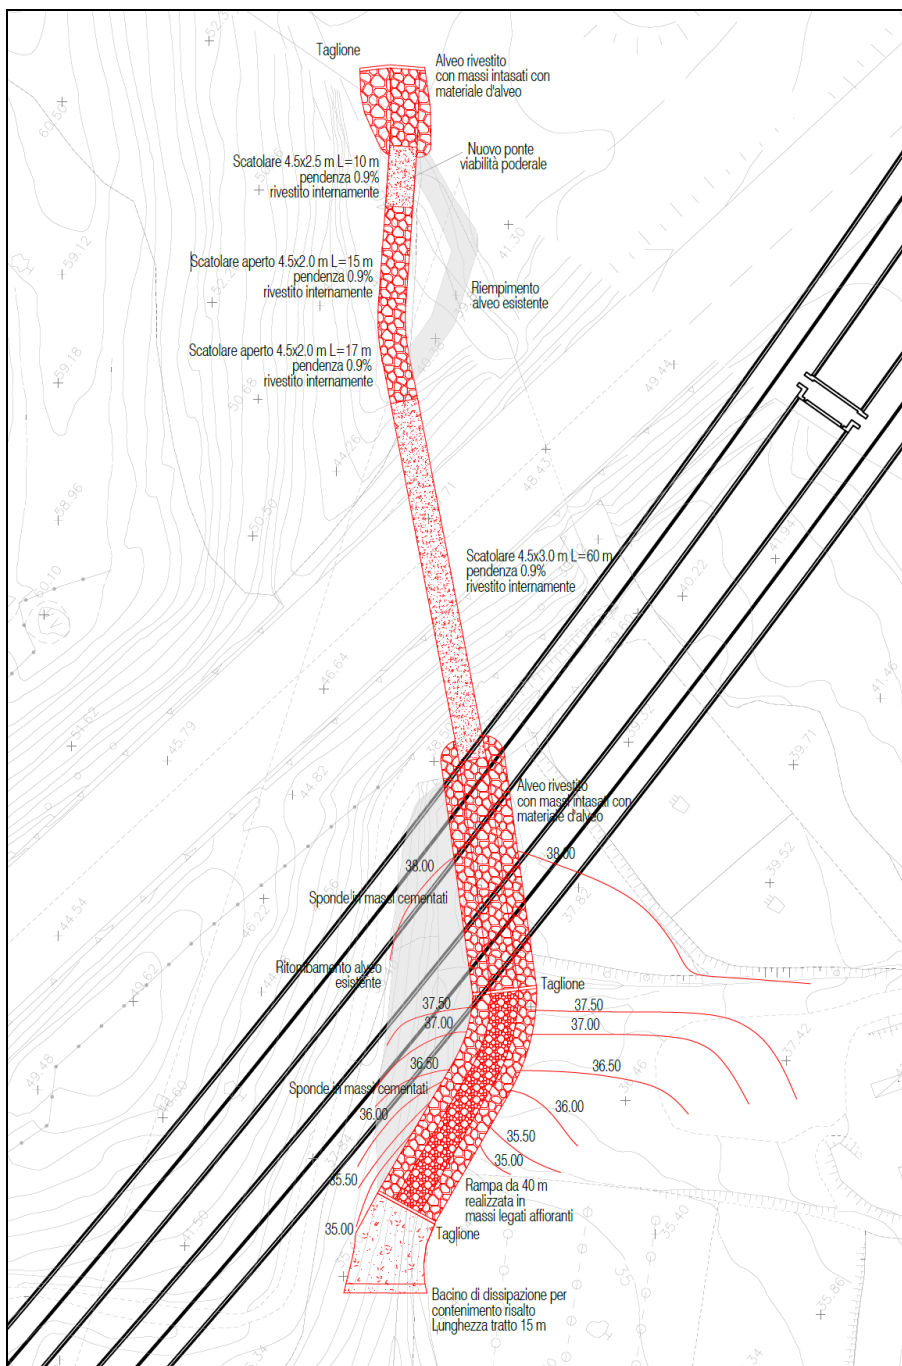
Pianta della sistemazione idraulica del Rio 81+972
